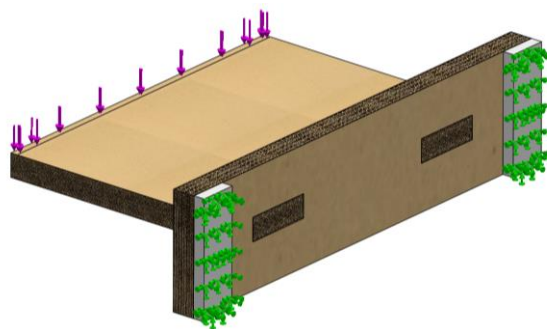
Configuración ensayo de carga estática sobre unión A-PH || Fuente: Elaboración propia
